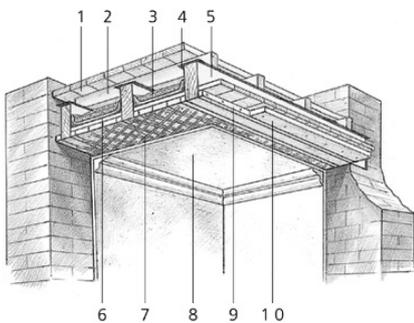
Соединение деревянных балок при опирании на внутреннюю стену:
